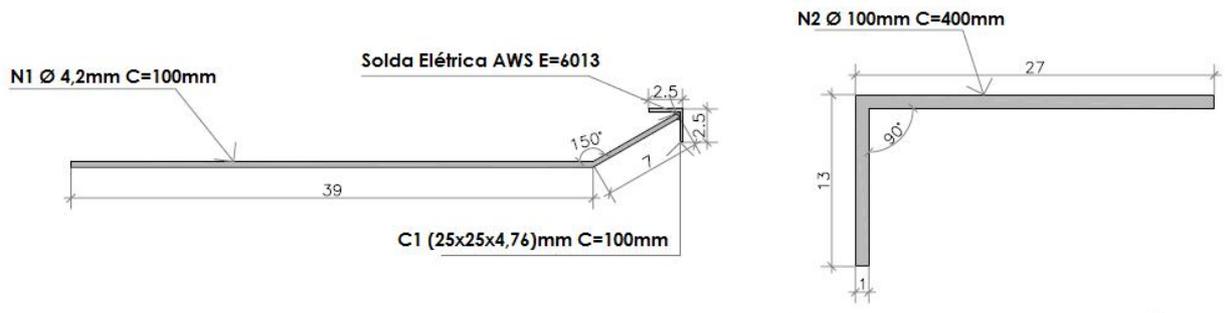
Detalhes dos dispositivos metálicos utilizados para ligação entre painéis.
